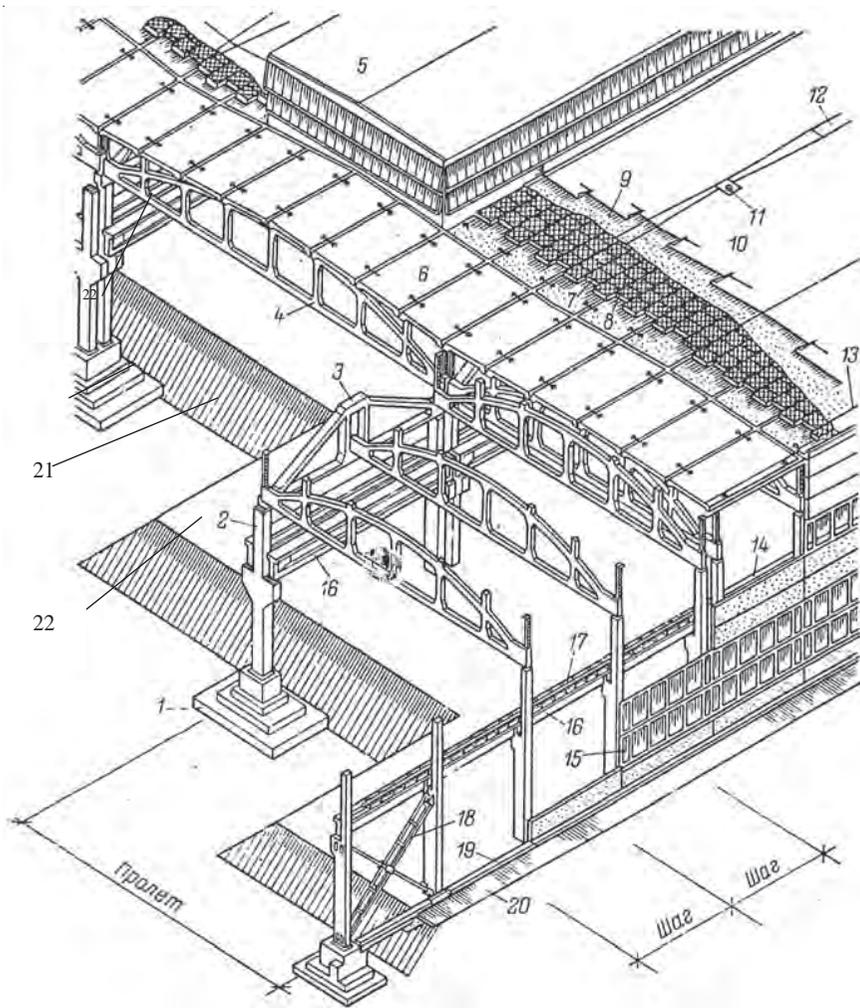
Конструктивные элементы одноэтажного здания с железобетонным каркасом:
